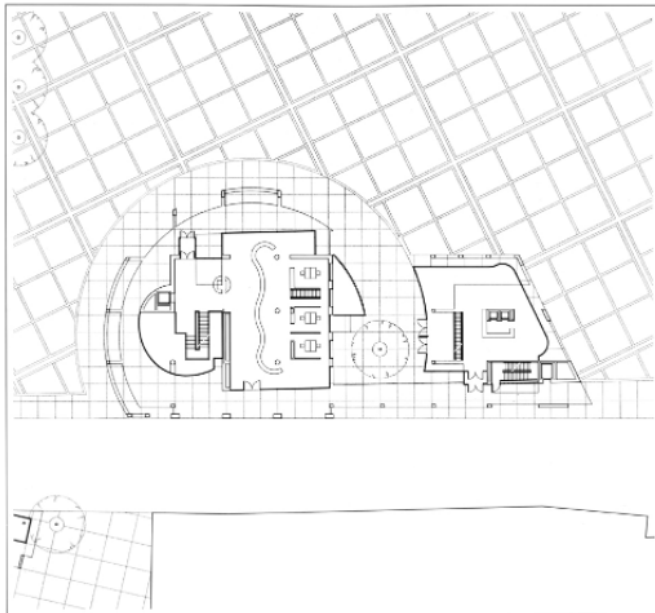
Primer piso, Stadhaus, Ulm (fuente: <https://www.richardmeier.com/?projects=ulm-stadhaus-exhibition-assembly-building>, 2016).
